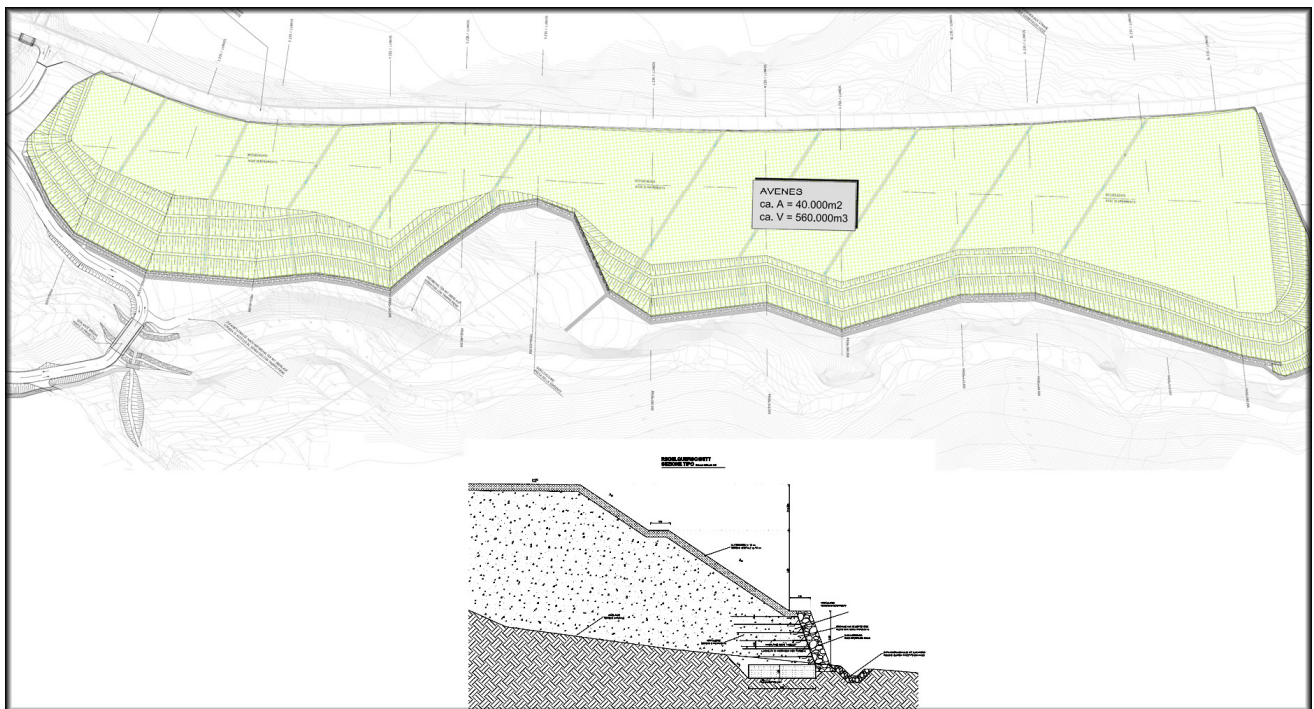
Lageplan und regelquerschnitt deponie Pfitsch -Afens
